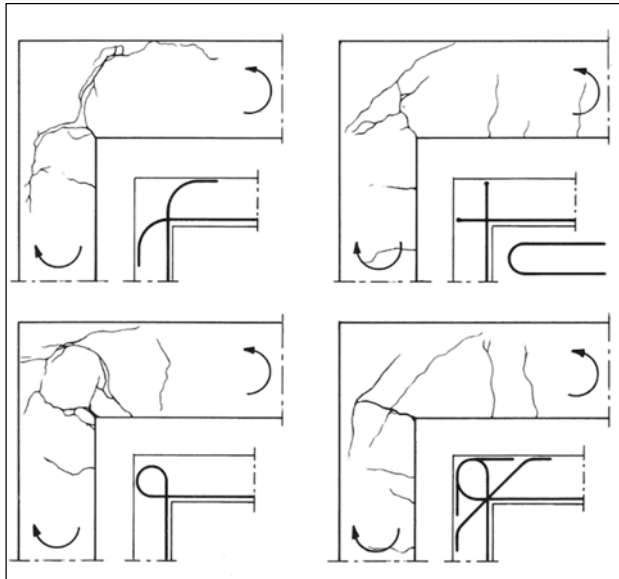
Rissbilder von Rahmenecken mit verschiedenen Bewehrungsarten bei positivem Moment. [Leonhardt – 1977]
